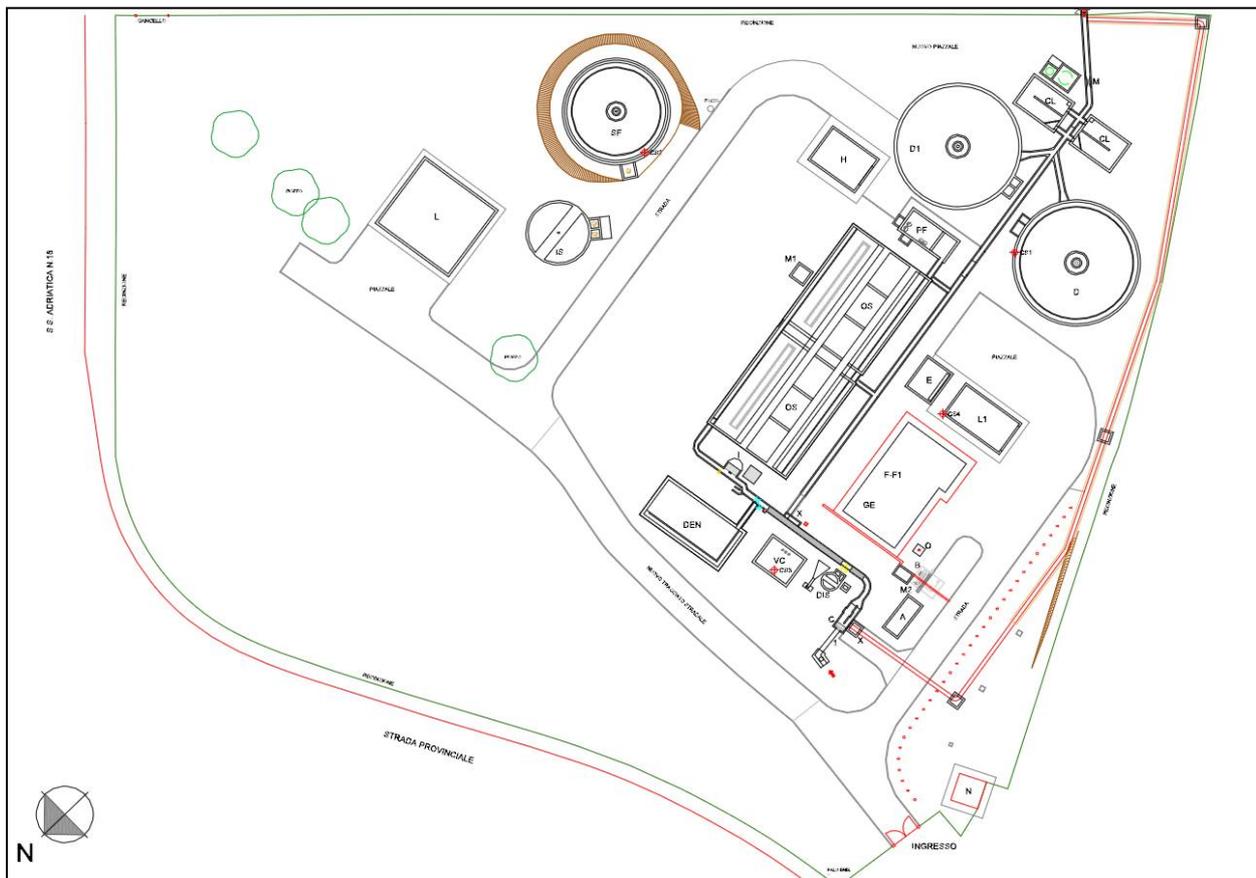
Planimetria dell'impianto di Marotta-Mondolfo
